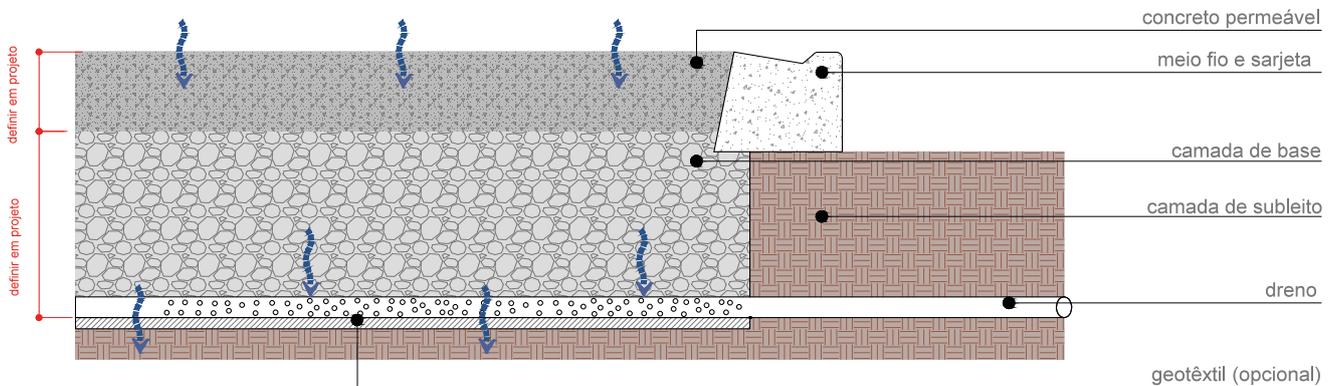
Esquema técnico de pavimento permeável com infiltração parcial no solo.
